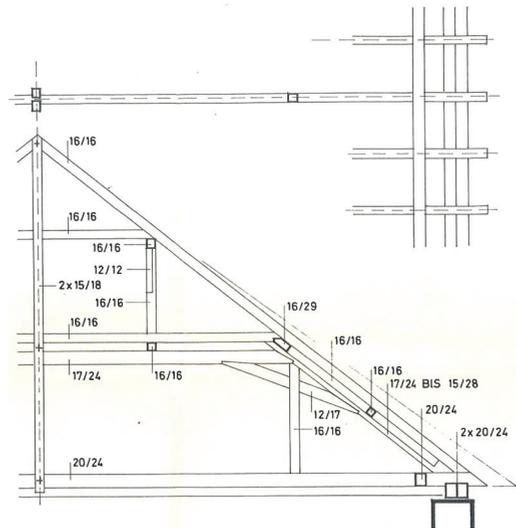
Querschnitt Dachstuhl Hauptgebäude 1:50
